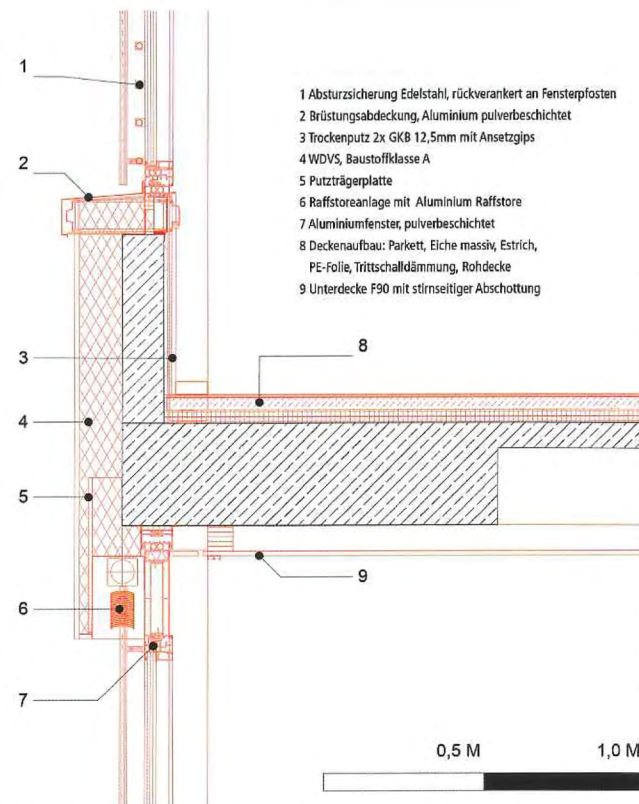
Fassadendetail nach Rückschnitt der Brüstungen (Quelle: Stefan Forster Architekten)
